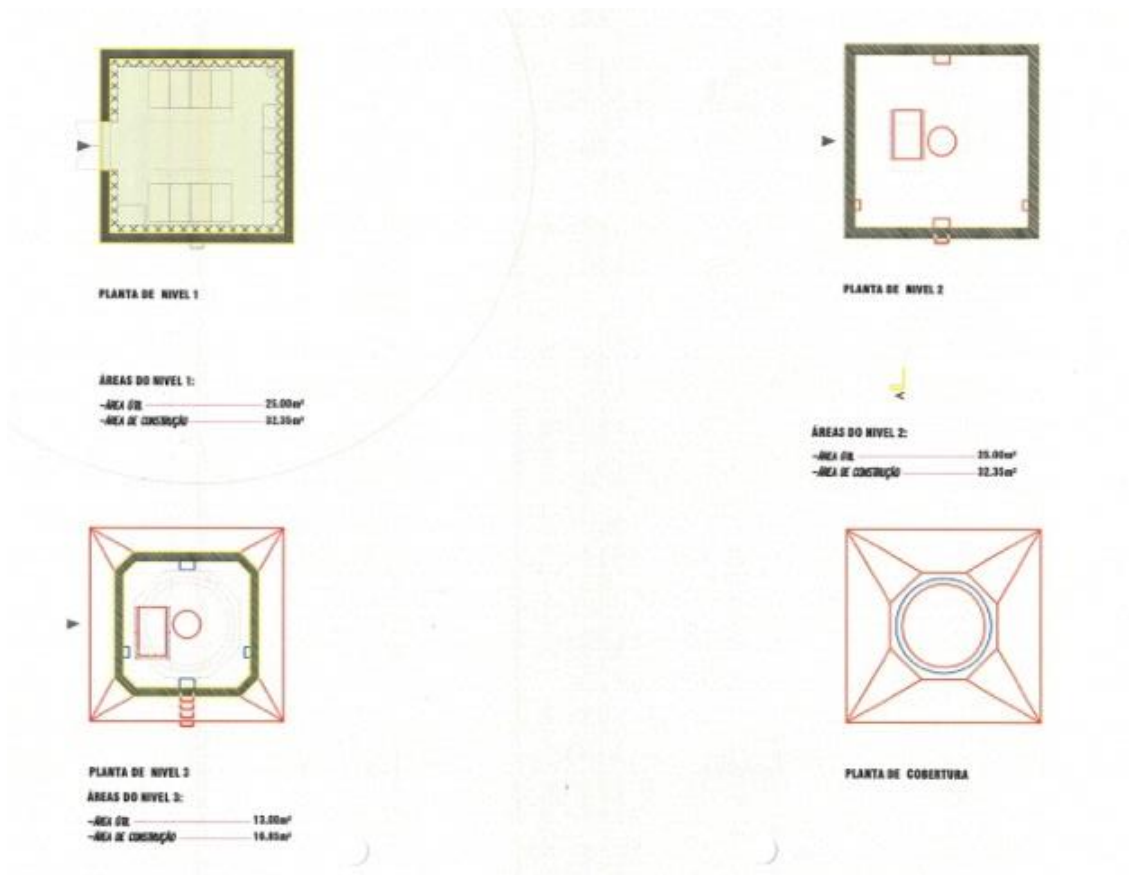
Planta de nível 1, 2 e 3 e planta de cobertura do edifício de torre da antena
